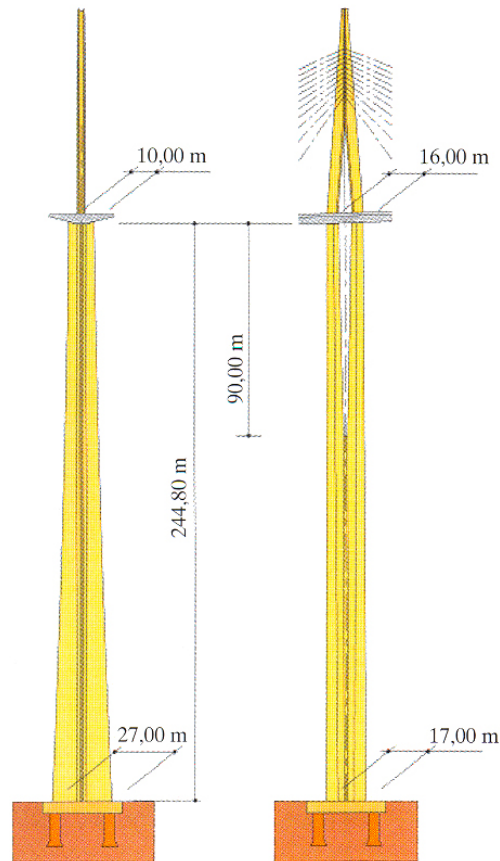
Alzado y perfil de una pila <sup>[F8]</sup>.
